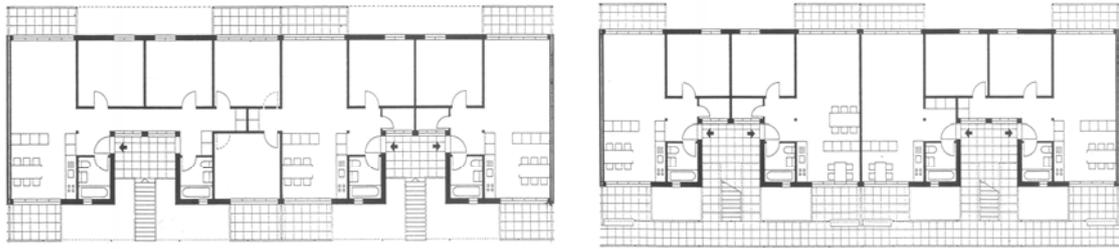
Verschiedene, mögliche Grundrissvarianten
